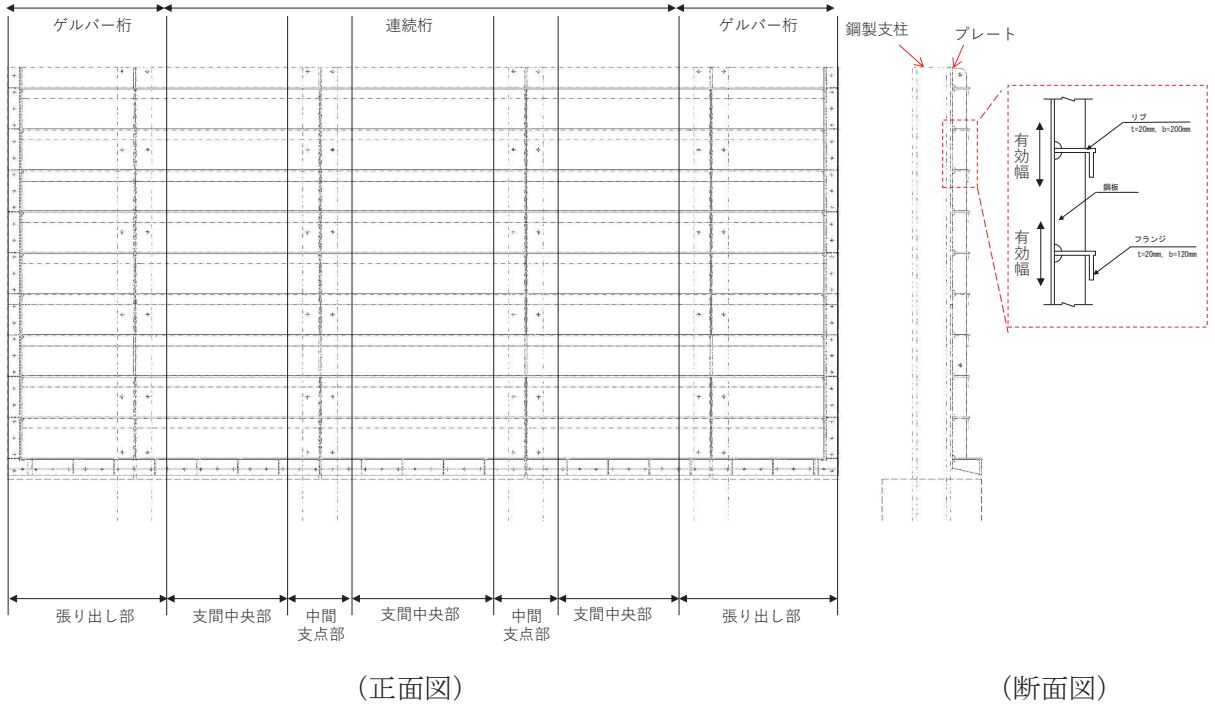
鋼板の構造図 (正面図, 断面図)
